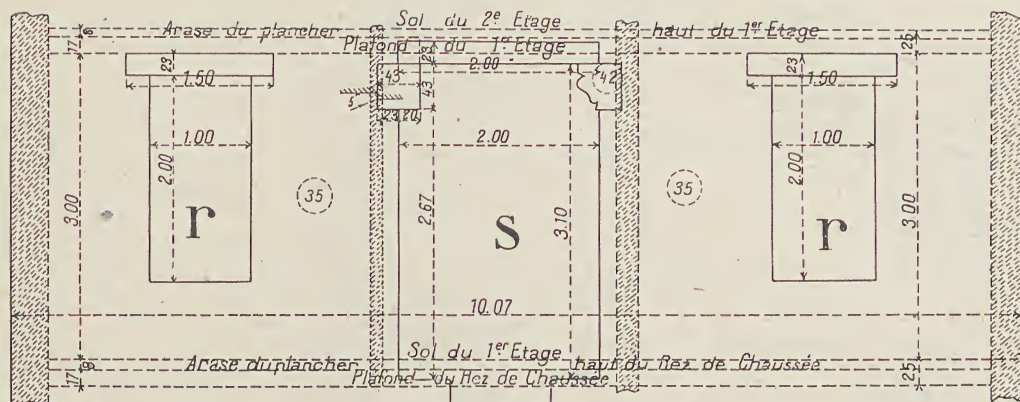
Façade latérale de gauche ; élévation vue du côté du jardin,
